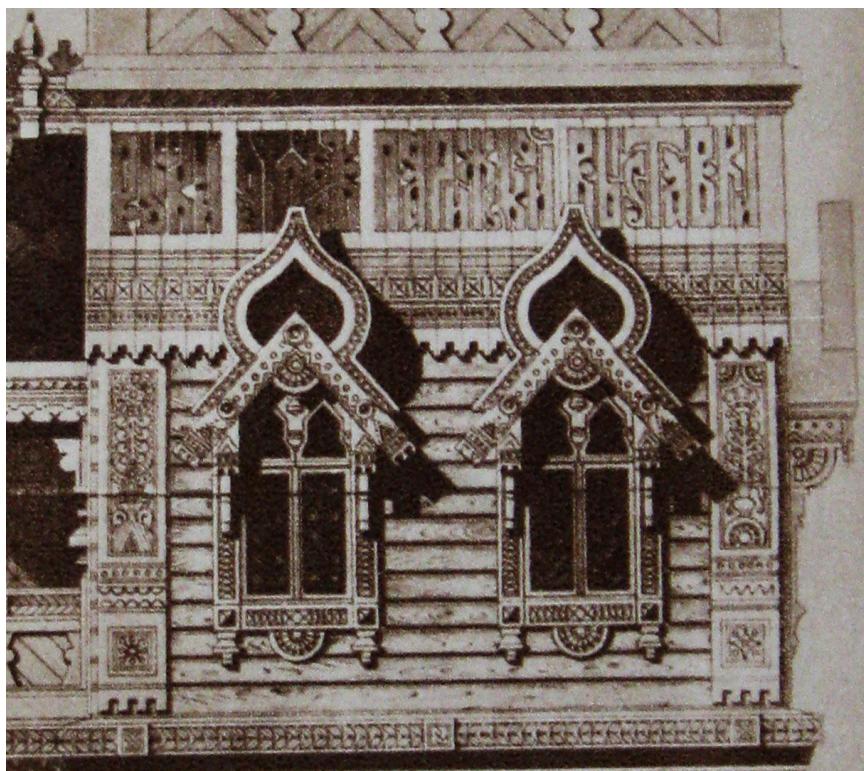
Фрагмент фасада павильона на всемирной выставке в Париже.
